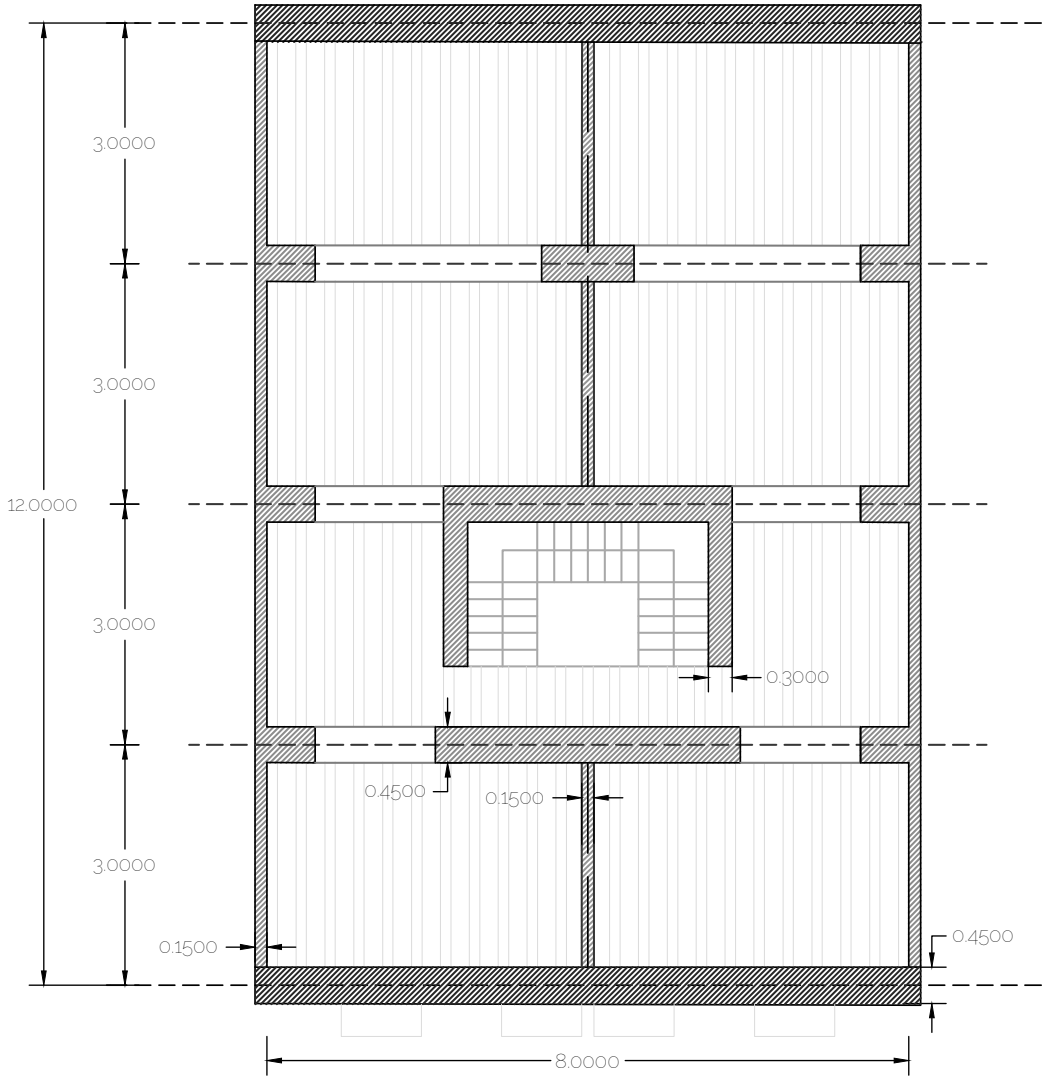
▲ Esquema de un edificio tipo B que muestra el sistema estructural mediante muros de carga paralelos a la fachada
